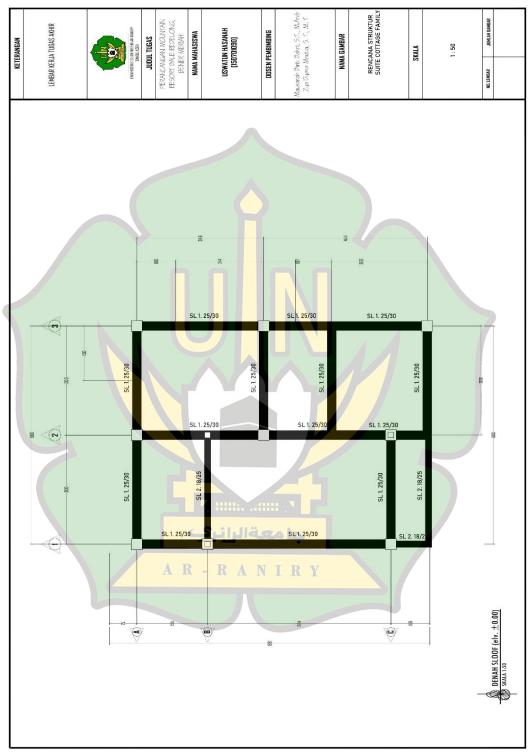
Rencana Sloof *Suite Couple* Sumber : Rancangan Pribadi
